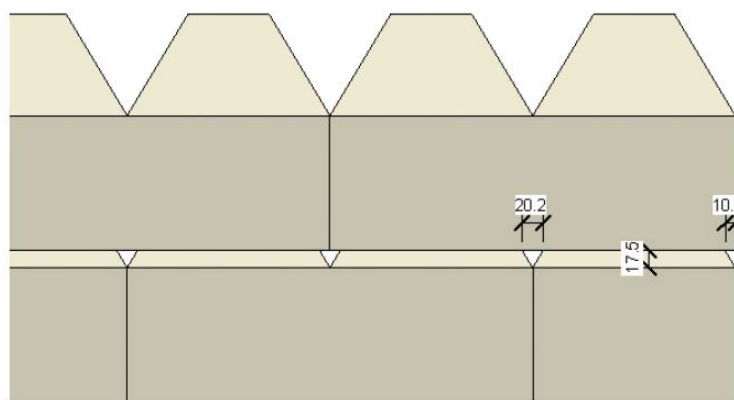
Jour entre les rangées de Dricks (en mm)
